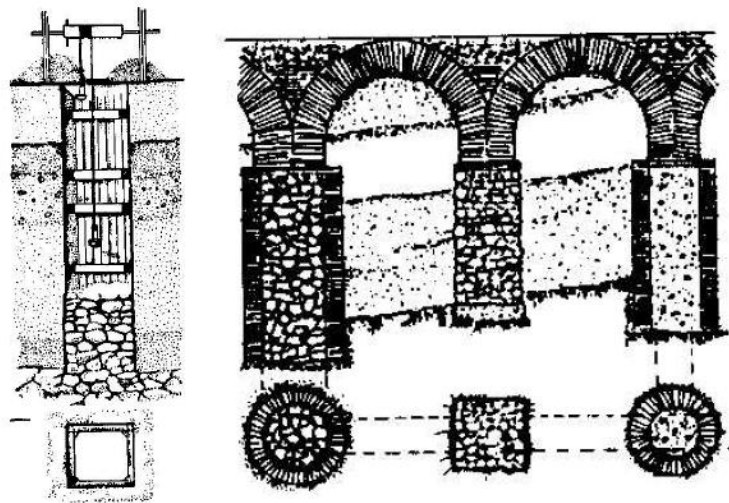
Esquemas de fundações sobre poços de alvenaria [27]: corte (em cima), e planta (em baixo)
